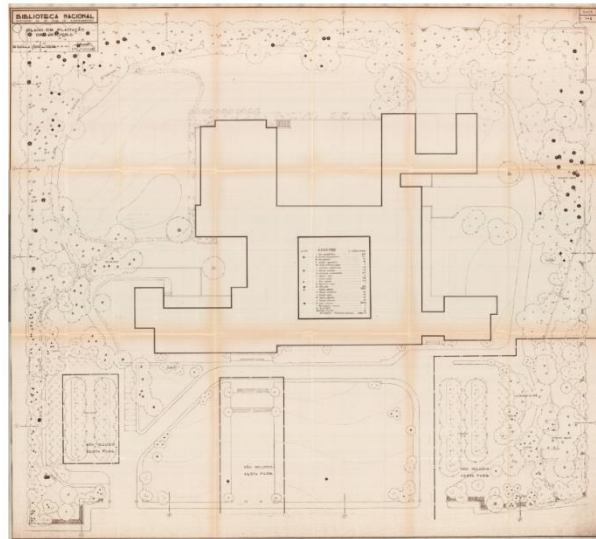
Projeto de Arranjos Exteriores da BNP – Arq.º Viana Barreto (1956).
